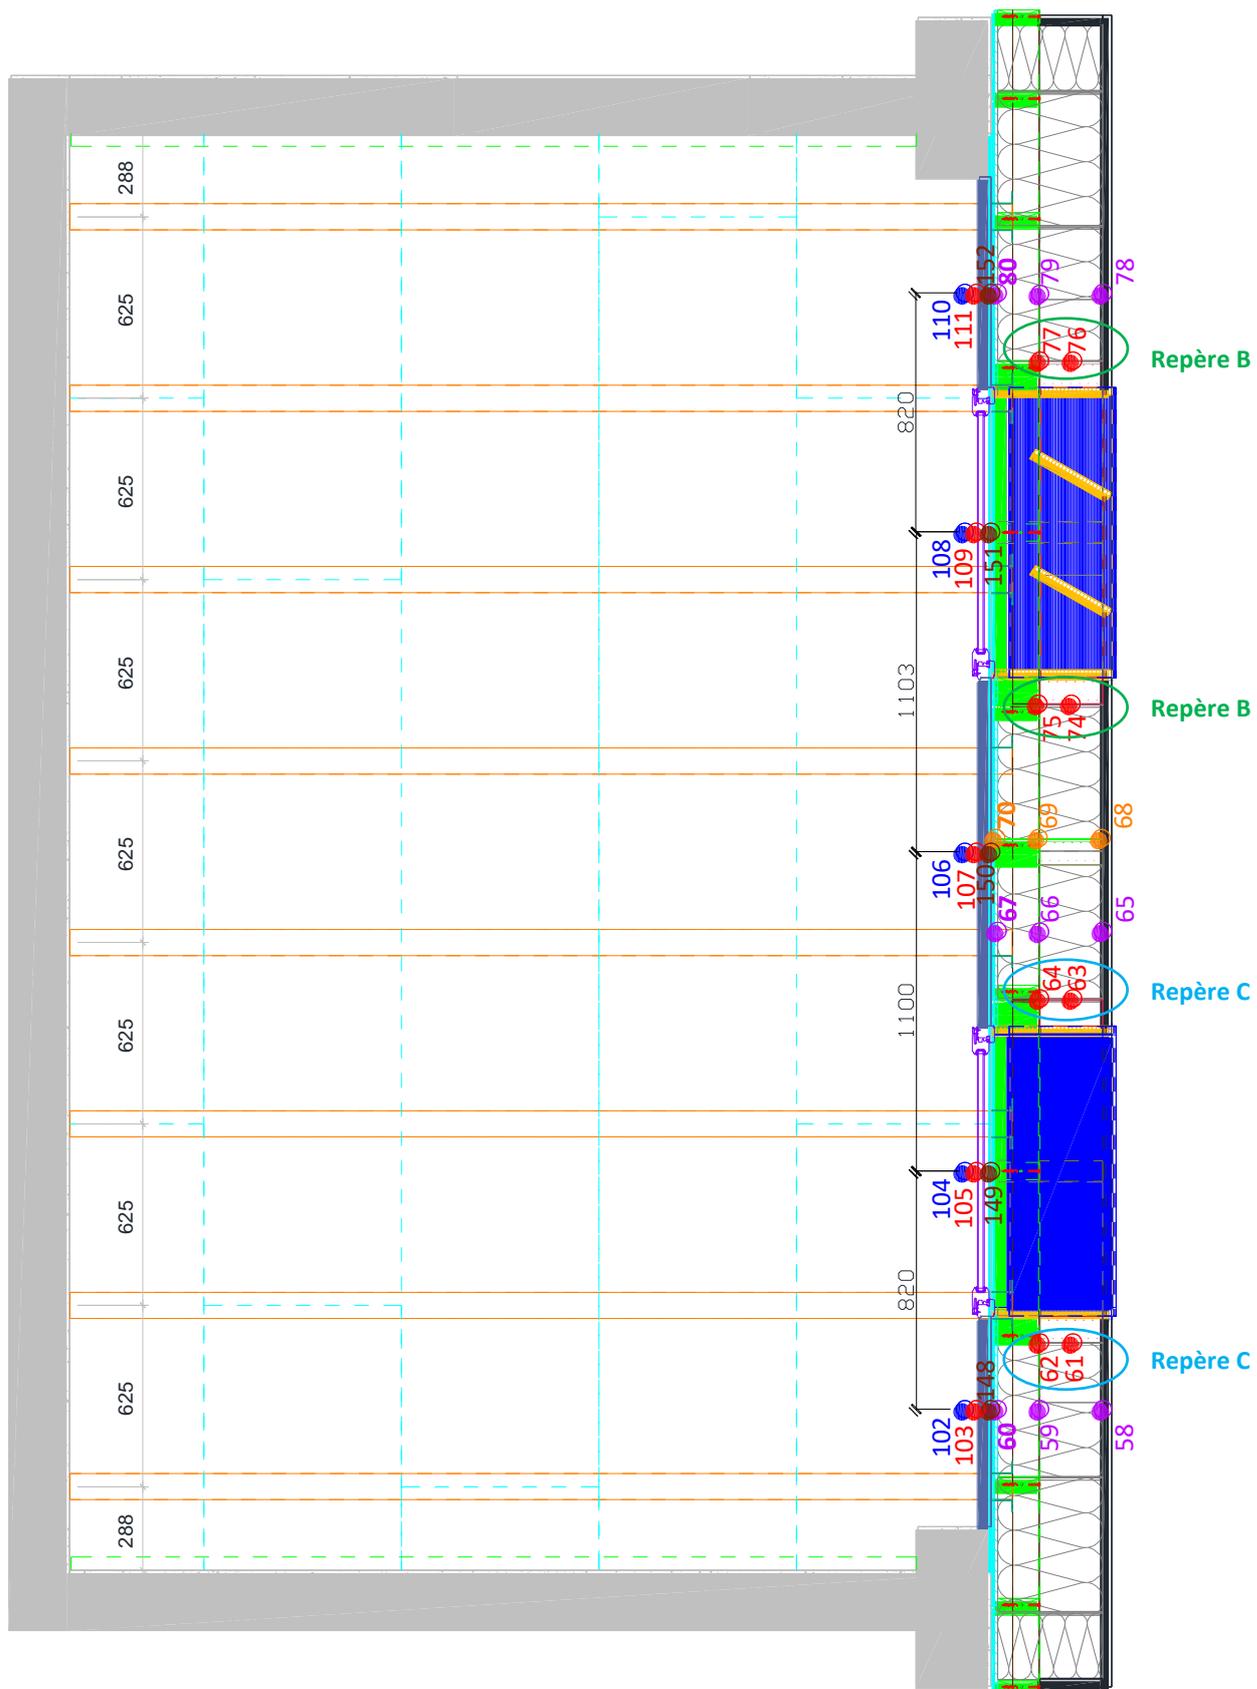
Instrumentation de l'élément de façade - Coupe I-I
